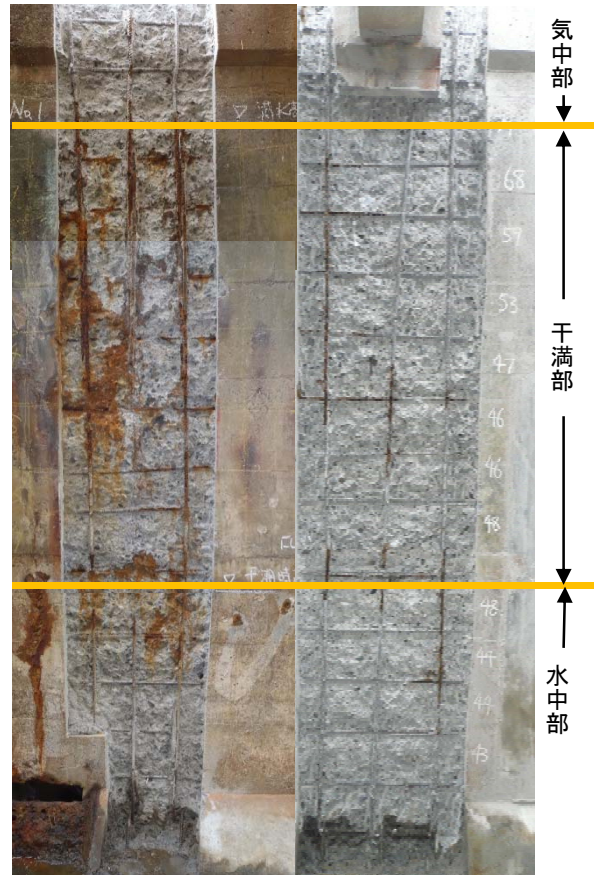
鉄筋腐食状況 (図-2, 3 赤点線囲み部分)
